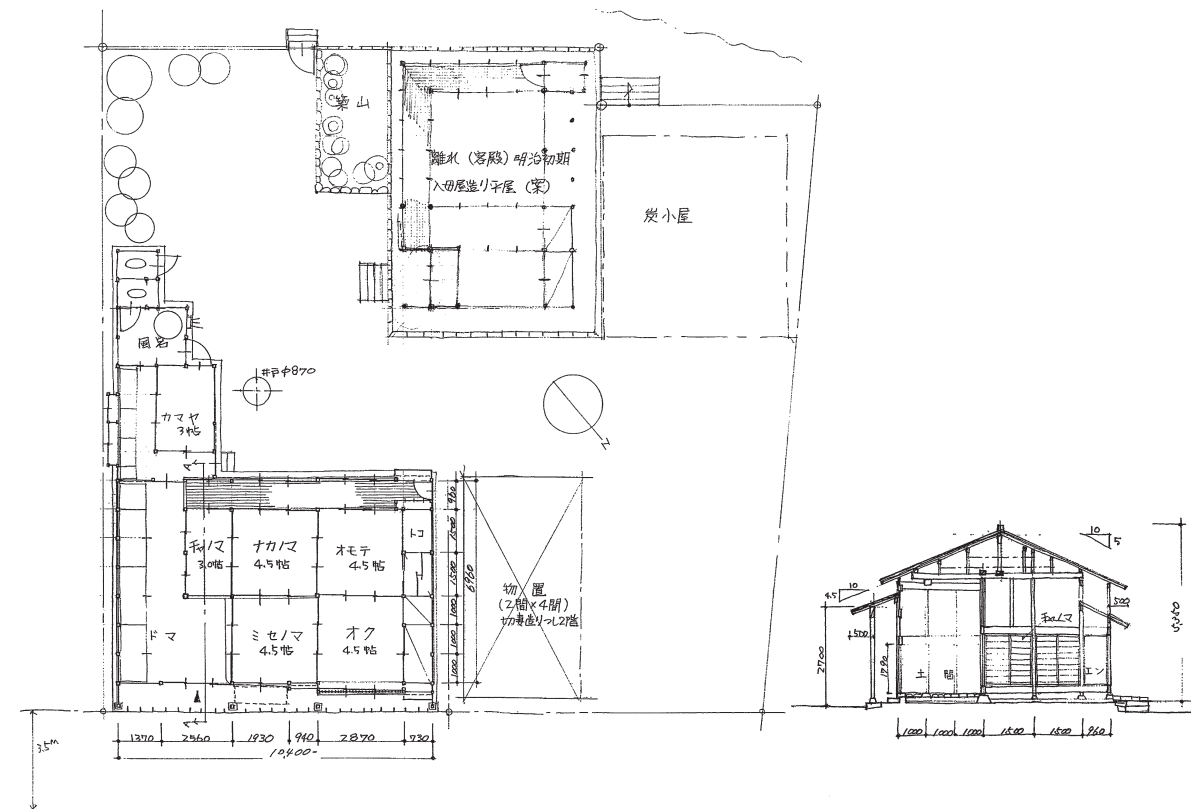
島村重助家住宅平面図・断面図 (1/250)
